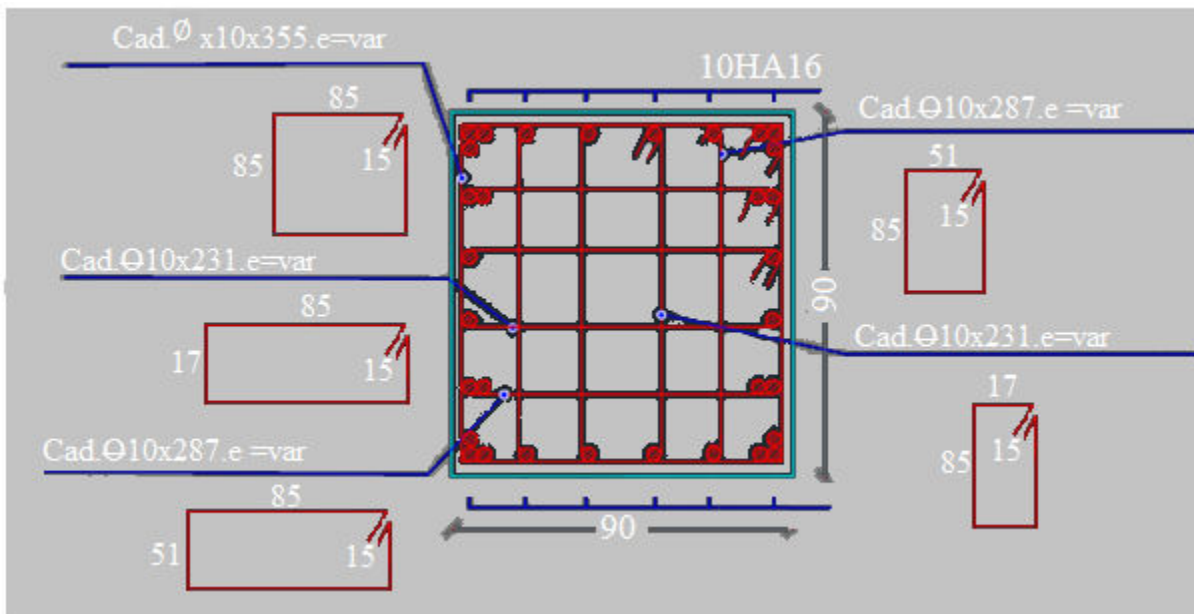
Coupe de ferrailage des poteaux 90×90 cm<sup>2</sup>
